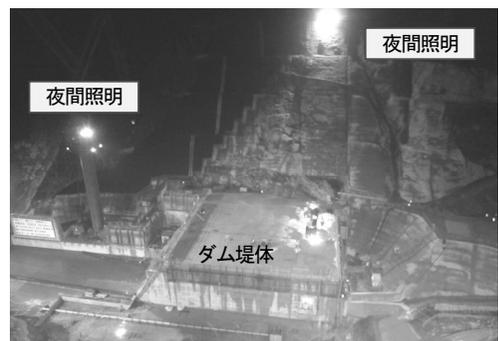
夜間工事照明事例(ダム堤体コンクリート打設)
